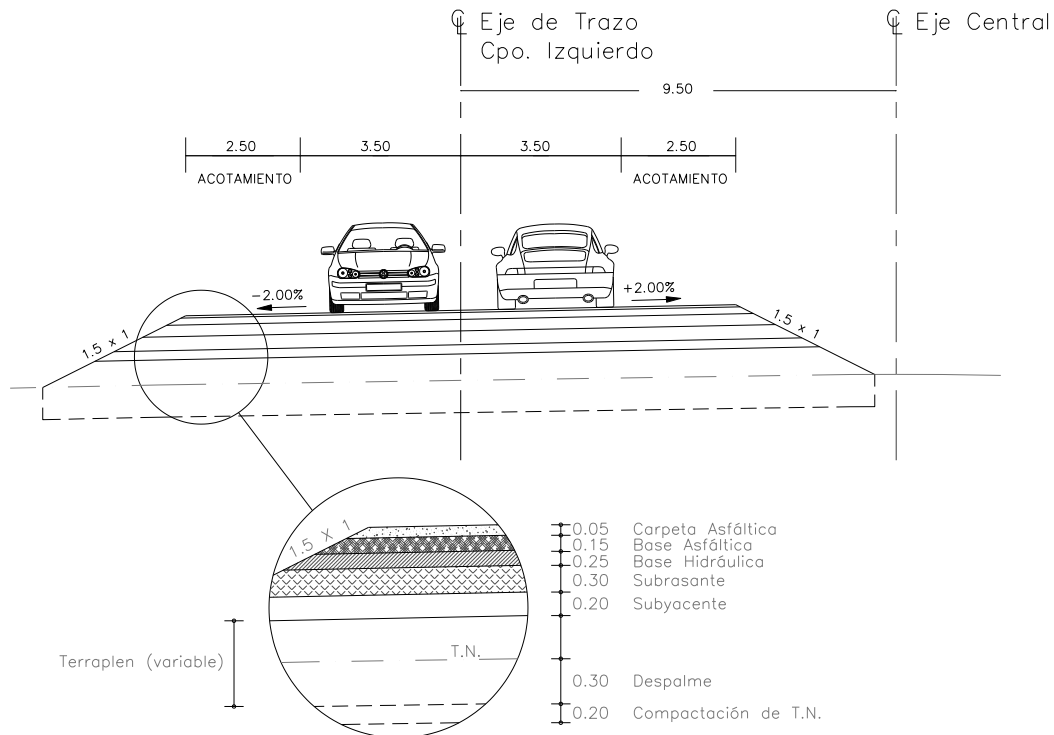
Sección Tipo de la Carretera y conformación de pavimentos.
